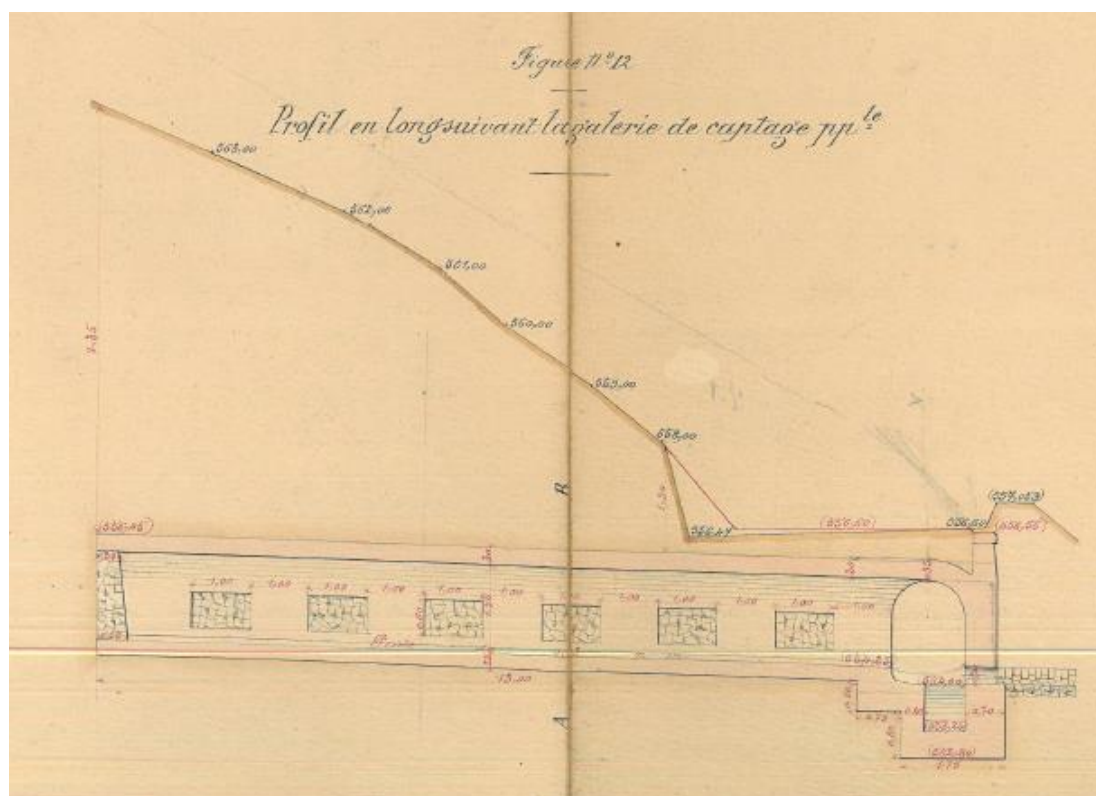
Profil en long suivant la galerie de captage (Source : Plan de 1889)
